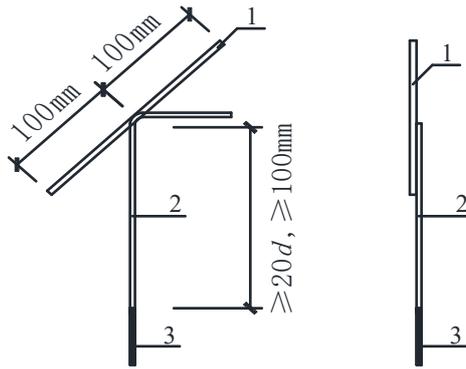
钢筋桁架、钢筋支架受剪试件
